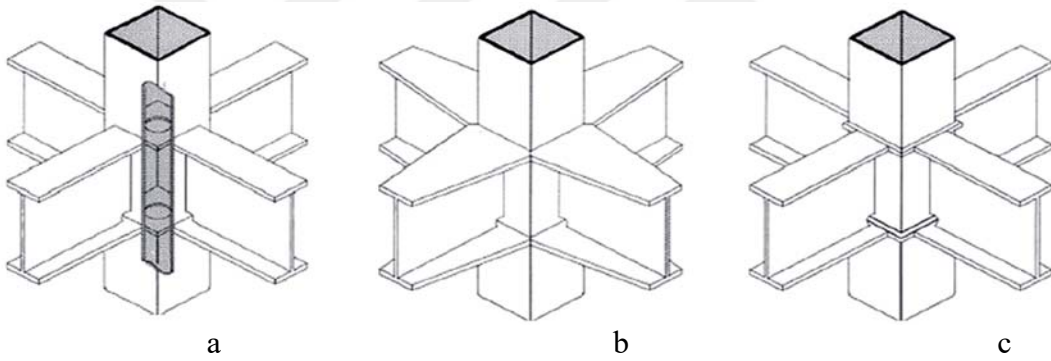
Beton dolgulı kompozit kolon-betonarme kiriş için önerilen geçiş elemanı (Chen vd., 2014)
